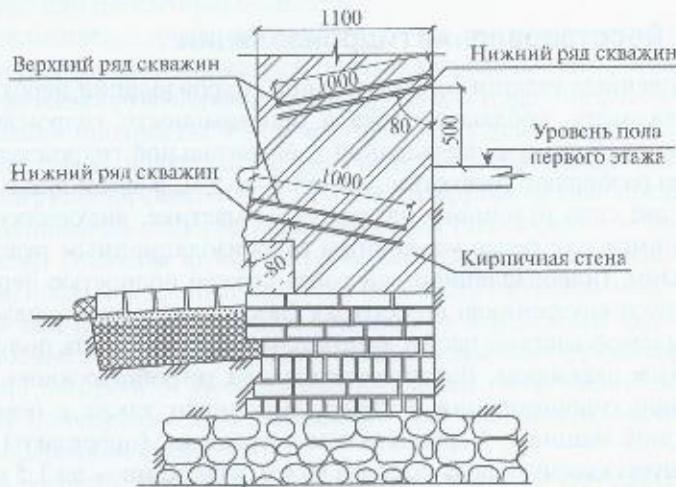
Устройство отсечной горизонтальной гидроизоляции инъектированием
